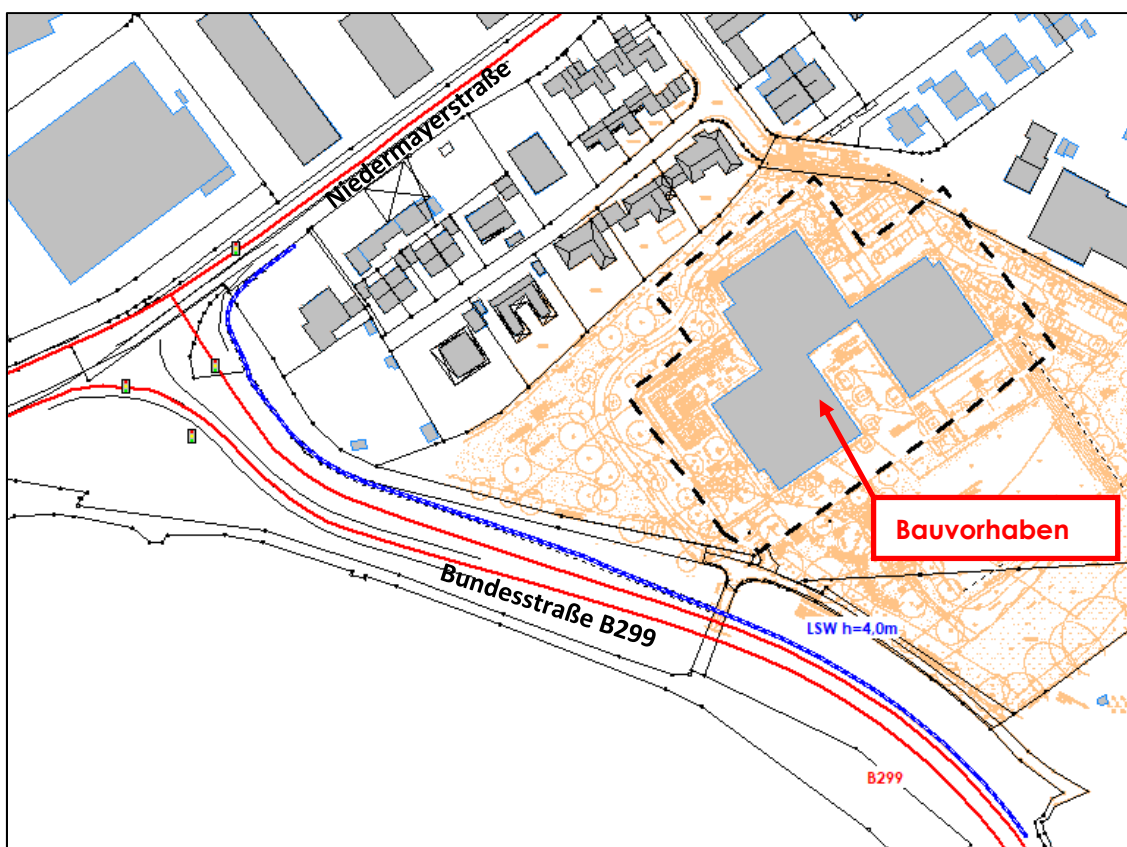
Lageplan mit Darstellung der relevanten Straßen
